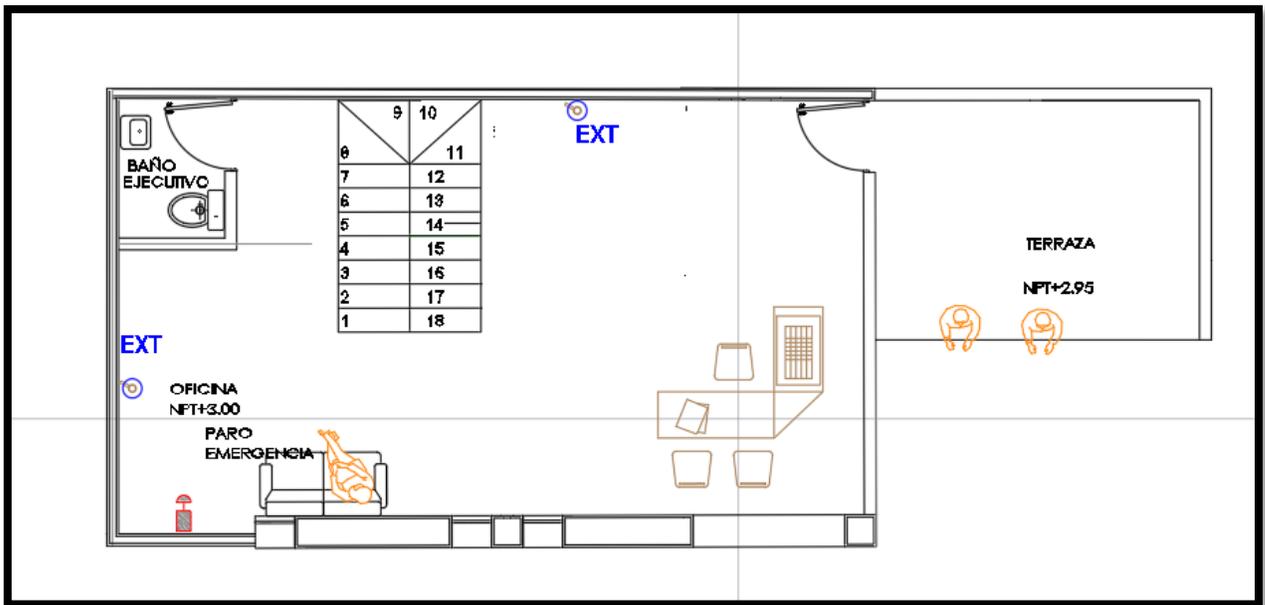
Extractos del Plano Arquitectónico del Proyecto
